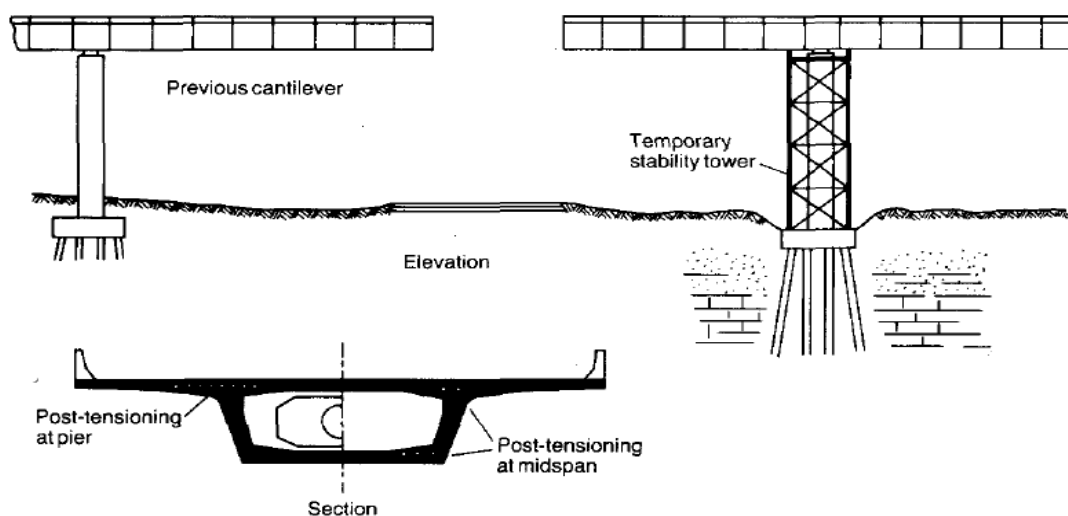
Esquema típico superestructura voladizo equilibrado. Adaptado de: Moreton A.J. (1990). Segmental bridge construction in Florida: a review and perspective.
